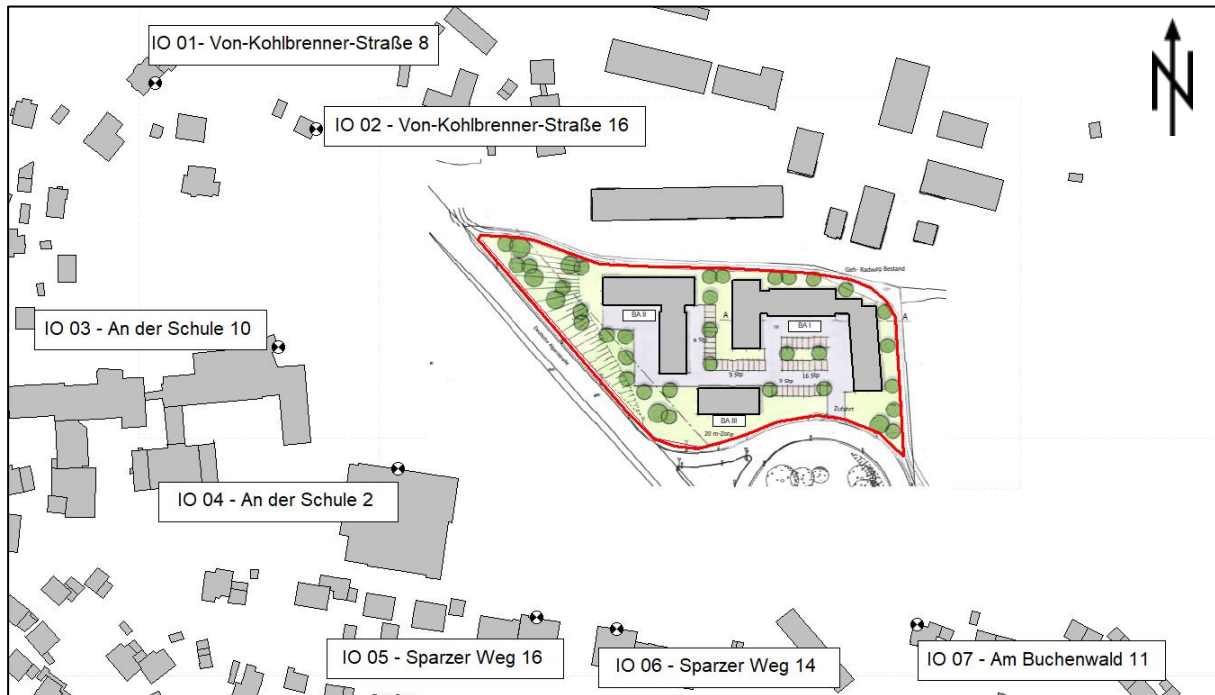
Lageplan mit Darstellung der maßgeblichen Immissionsorte [8]
